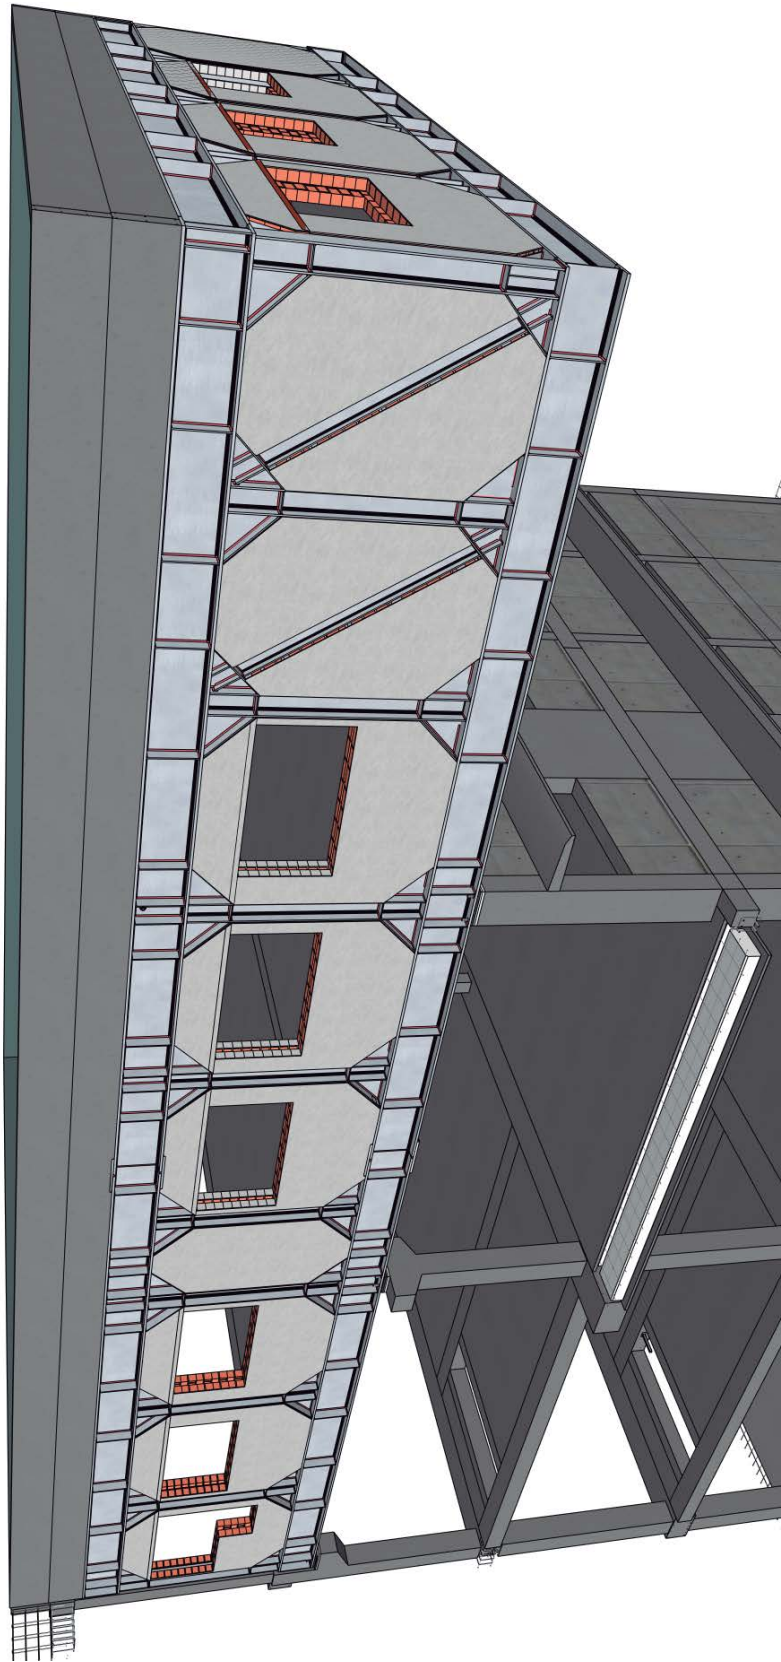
Cierre exterior de la estructura metálica del voladizo
